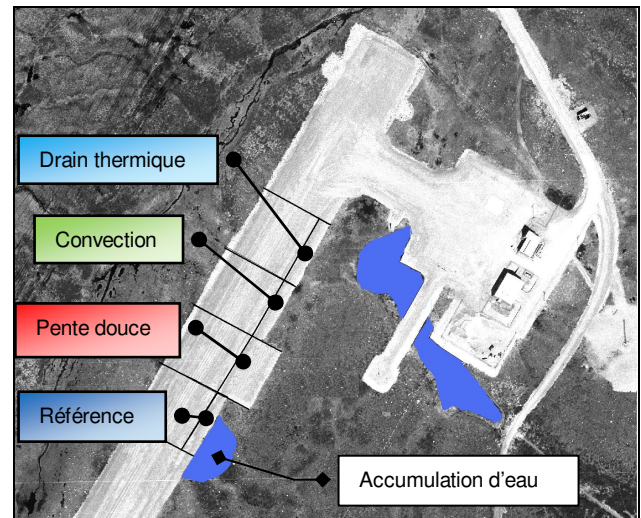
Vue en plan du site d'essai sur la piste d'atterrissage à Tasiujaq et localisation de l'accumulation d'eau (Ficheur et Doré, 2009)
